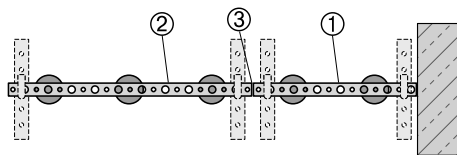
Przykłady zestawów złożonych z elementów 2 lub 3 trzpieniowych
